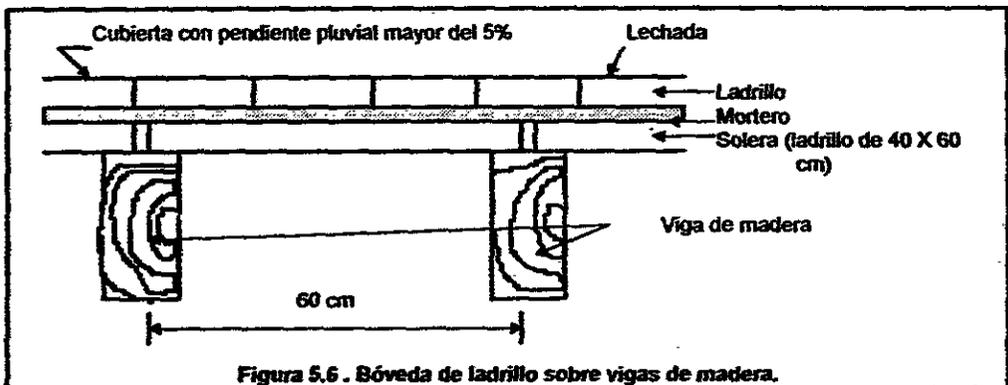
Bóveda de ladrillo sobre vigas de madera.
